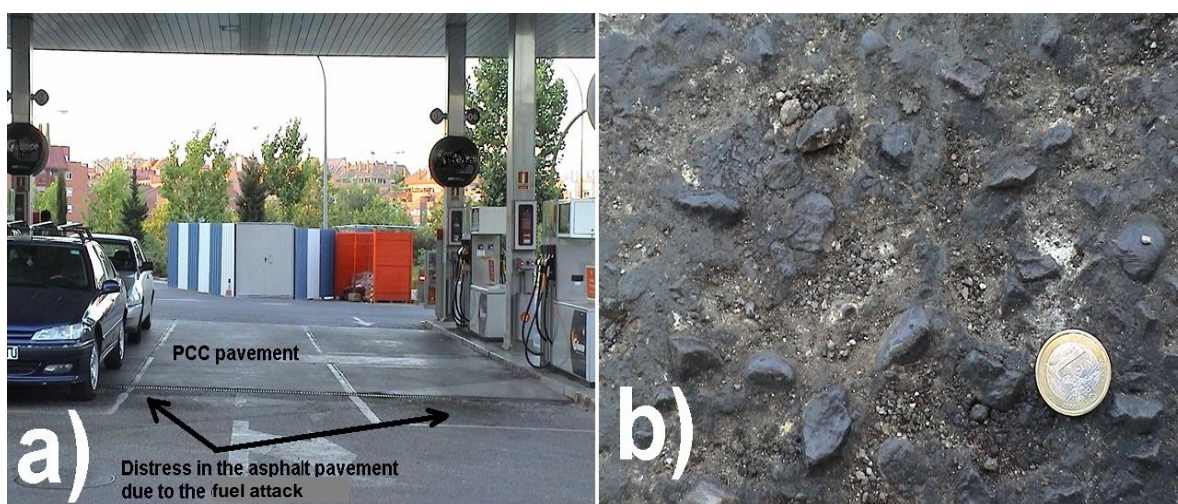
a) Pavimento asfáltico afectado por el carburante. b) Detalle de deterioro del pavimento
